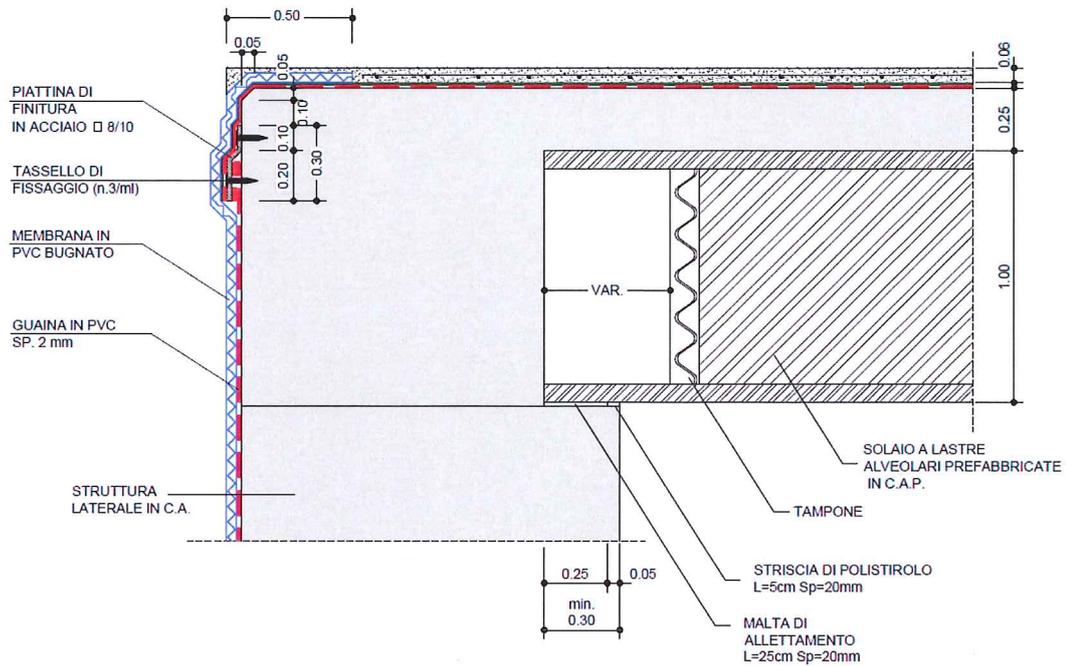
Particolare impermeabilizzazione risolto su travi prefabbricate (Sezione scatolare)
